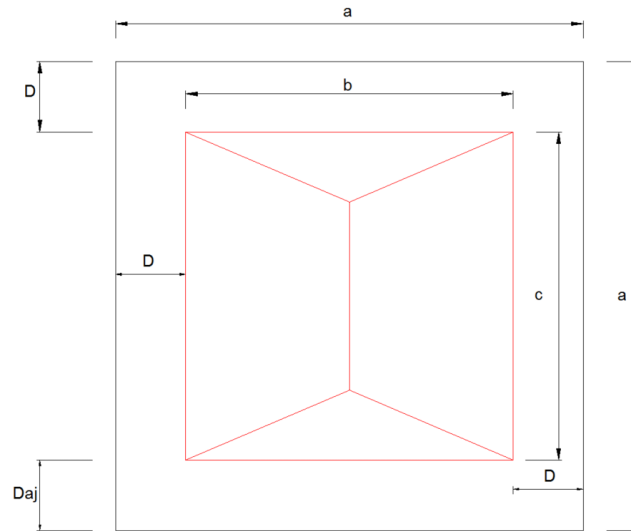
Casa tipo aislada con sus parámetros. Fuente: Elaboración propia.
